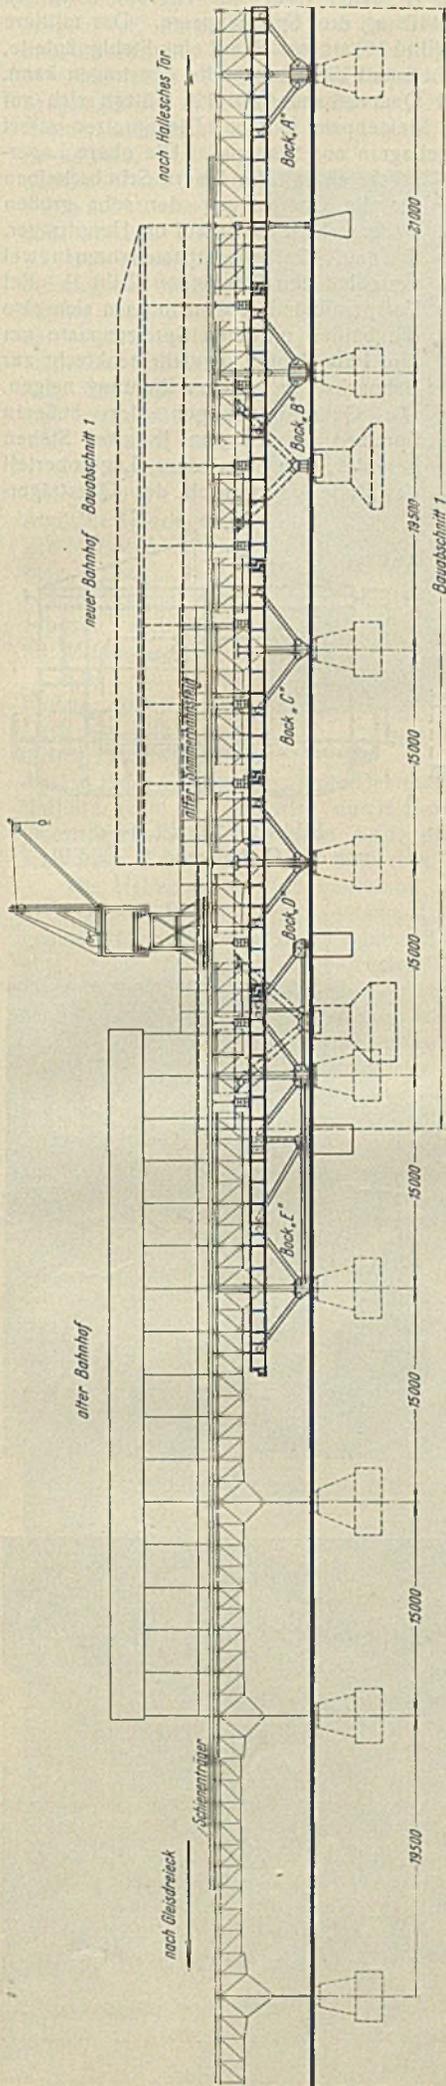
Erster Bauabschnitt. Die Hochbahnzüge fahren über die Montagerüstung, der neue Bahnhof ist im Bau, der alte Bahnhof ist noch in Betrieb.
